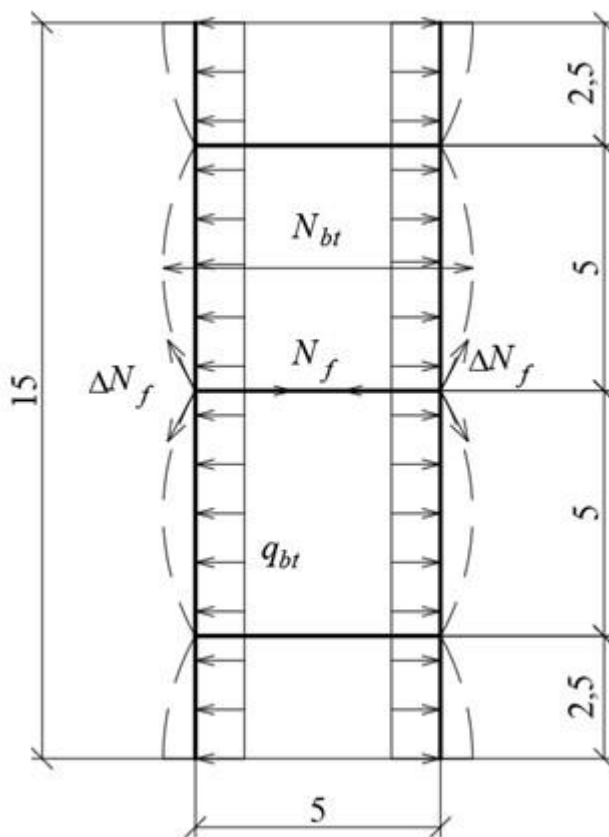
Схема действия усилий в растянутом бетоне и стекловолоконной сетке: q_{bt} – распределенное усилие от растянутого бетона; N_{bt} – усилие в выделенном фрагменте; N_f и ΔN_f – усилия в растянутом стержне стекловолоконной сетки
